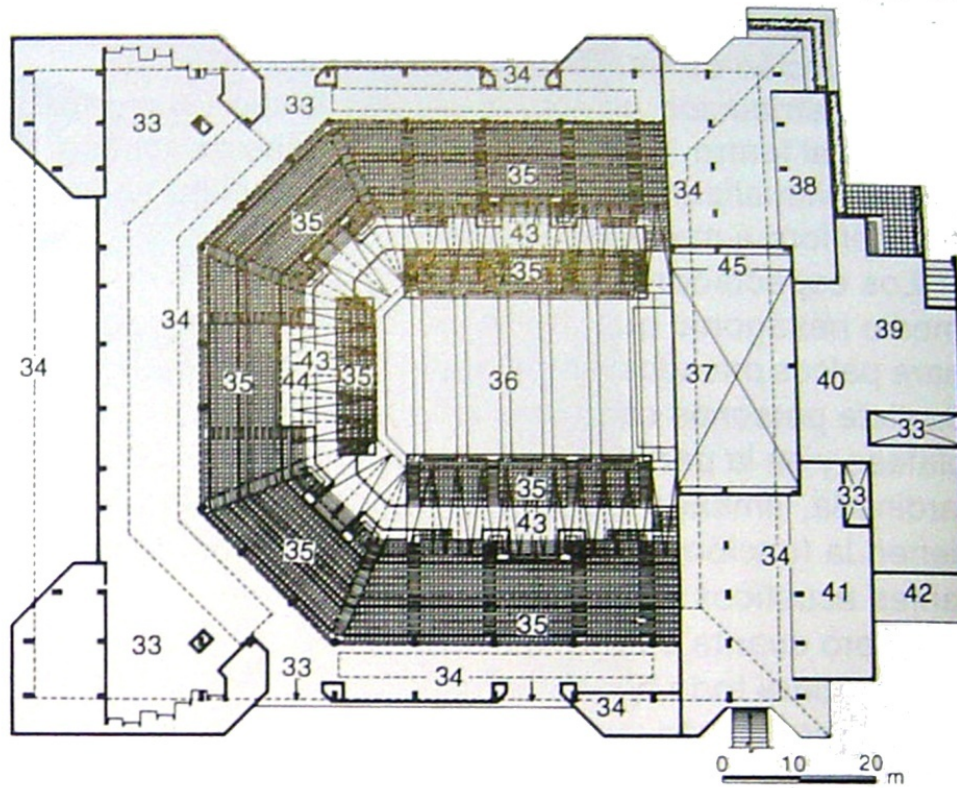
Planta arquitectónica del auditorio Josefa Ortiz de Domínguez.
